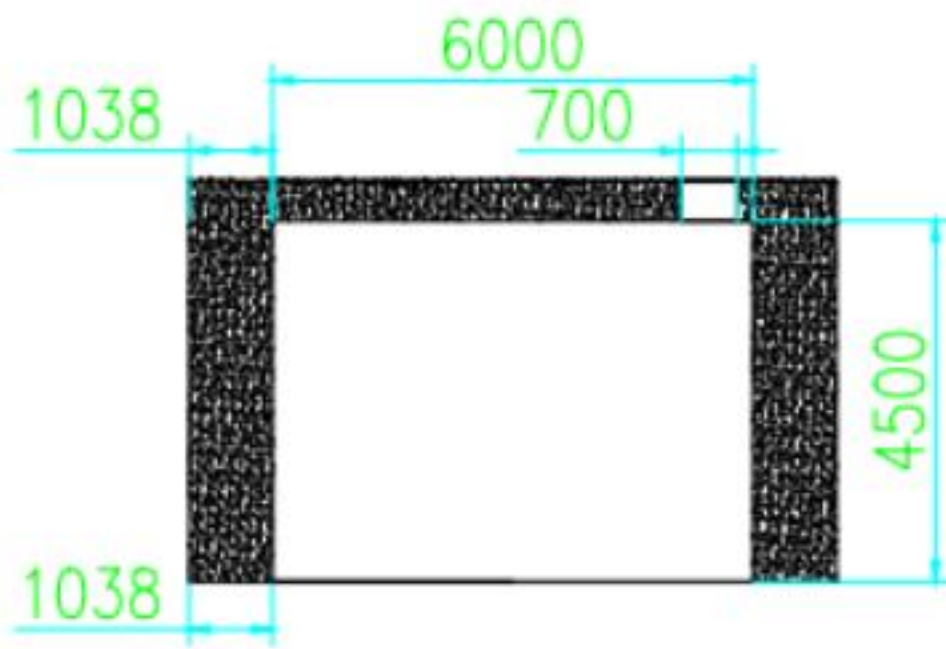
(c) 探伤工作场所 2-2 剖面示意图
